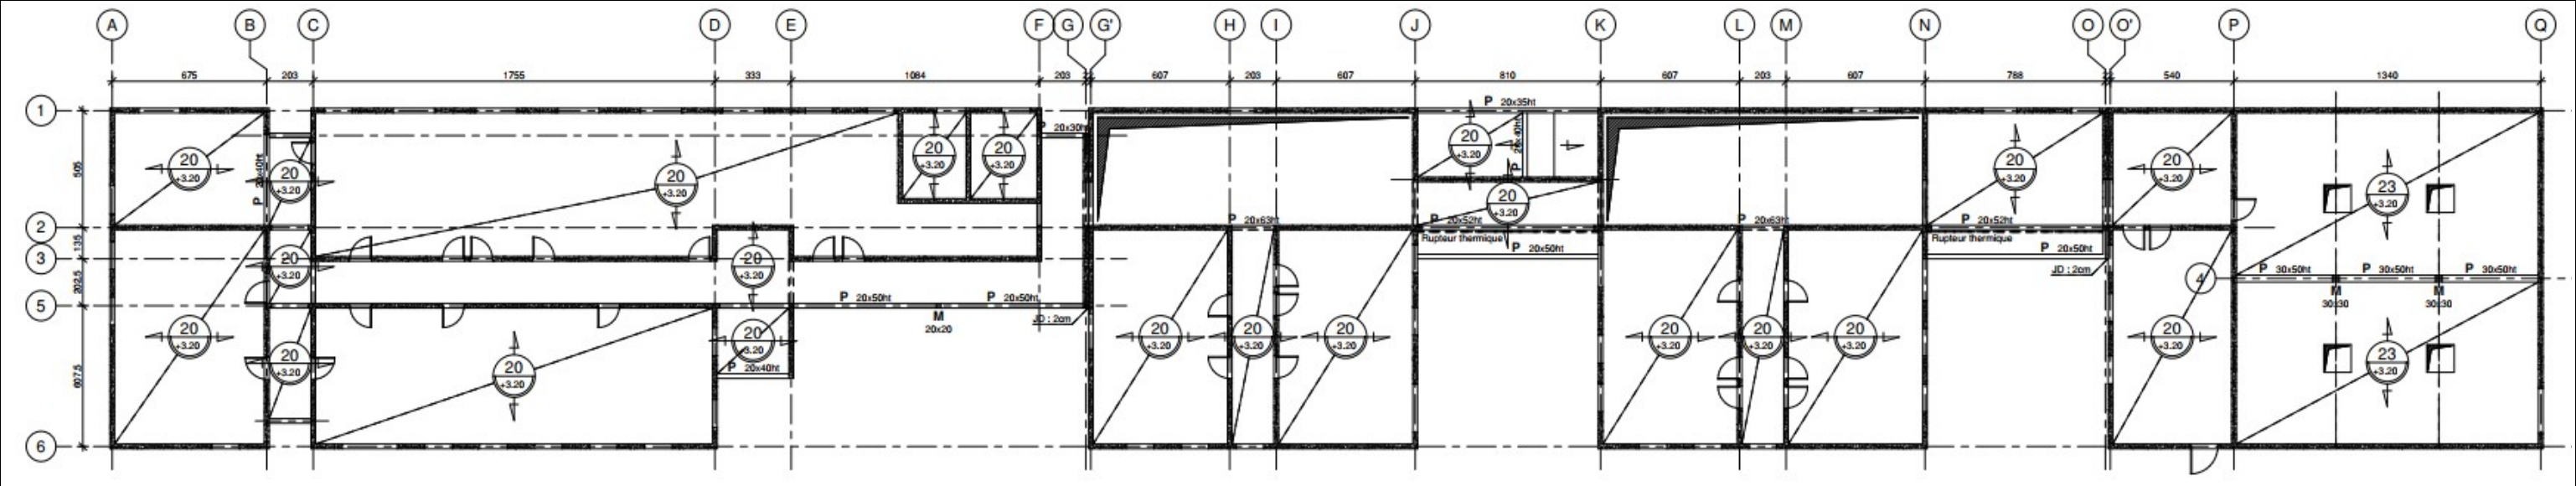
Plan projet du plancher haut du rez-de-chaussée
